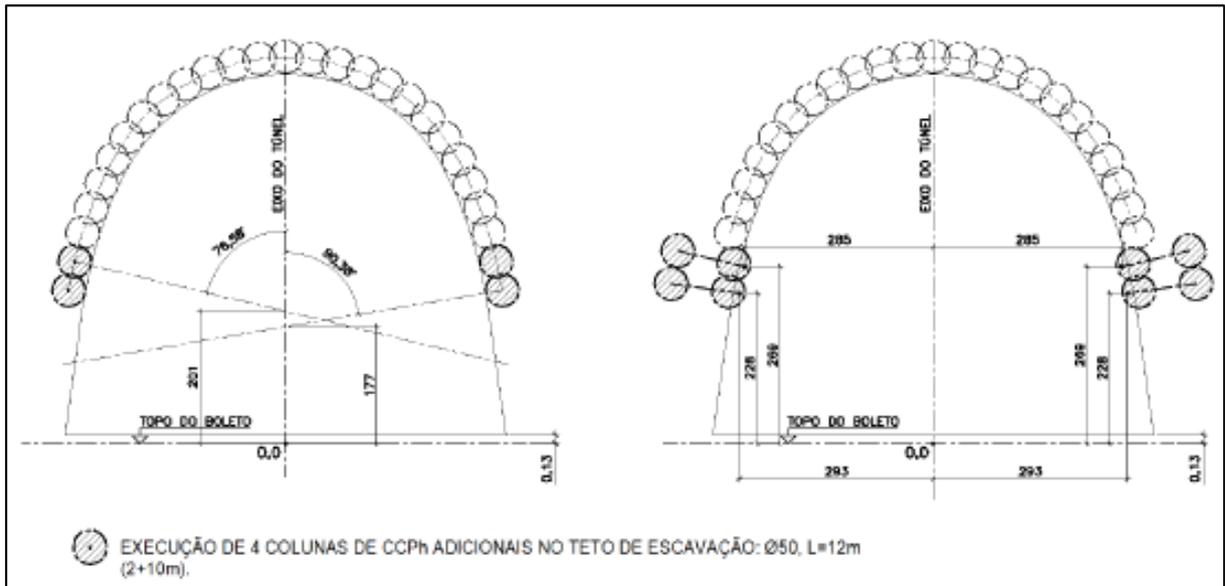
Tratamento de teto executado fora da área de baixa cobertura
